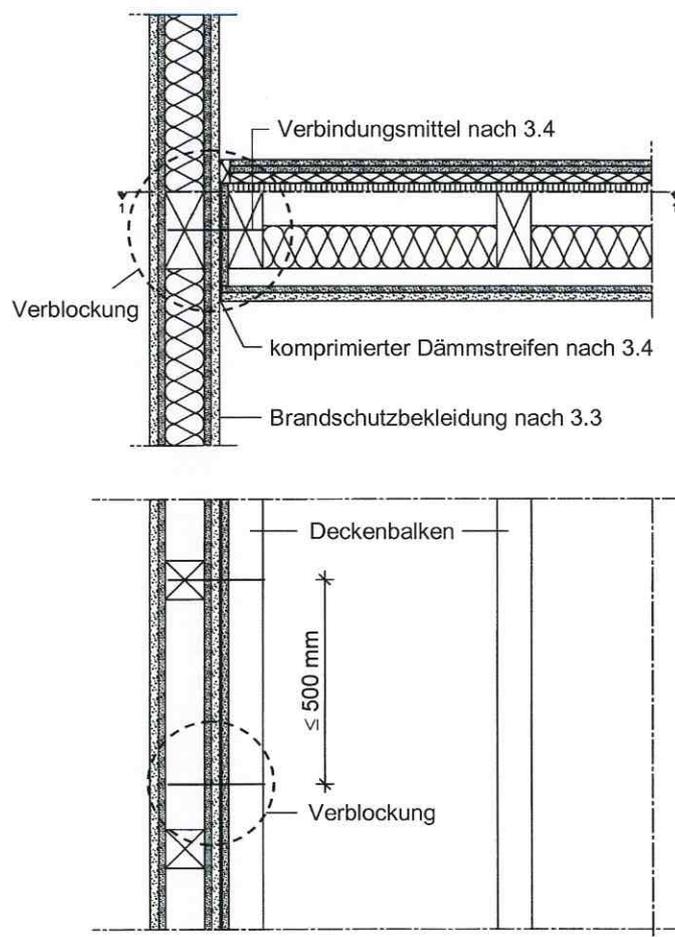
Anschluss einer Decke an eine durchlaufende tragende, raumabschließende Wand (Spannrichtung der Decken parallel zur Wand)
